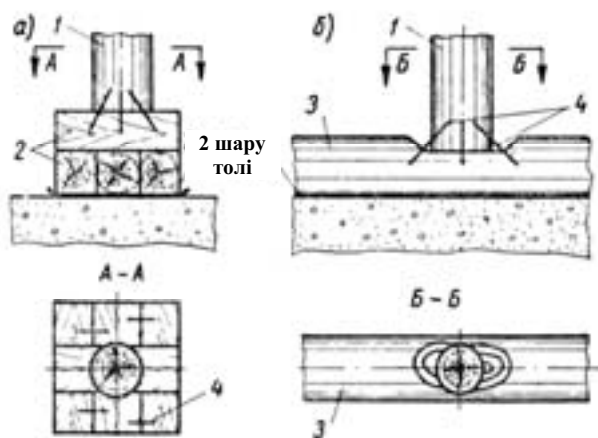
Вузол з'єднання дерев'яної стійки підсилення з фундаментом;
